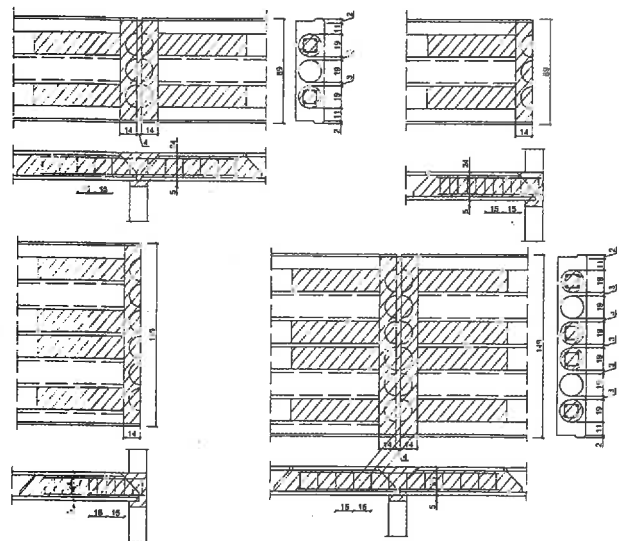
Przekroje wieńców poza trzpieniami w płytach stropowych
